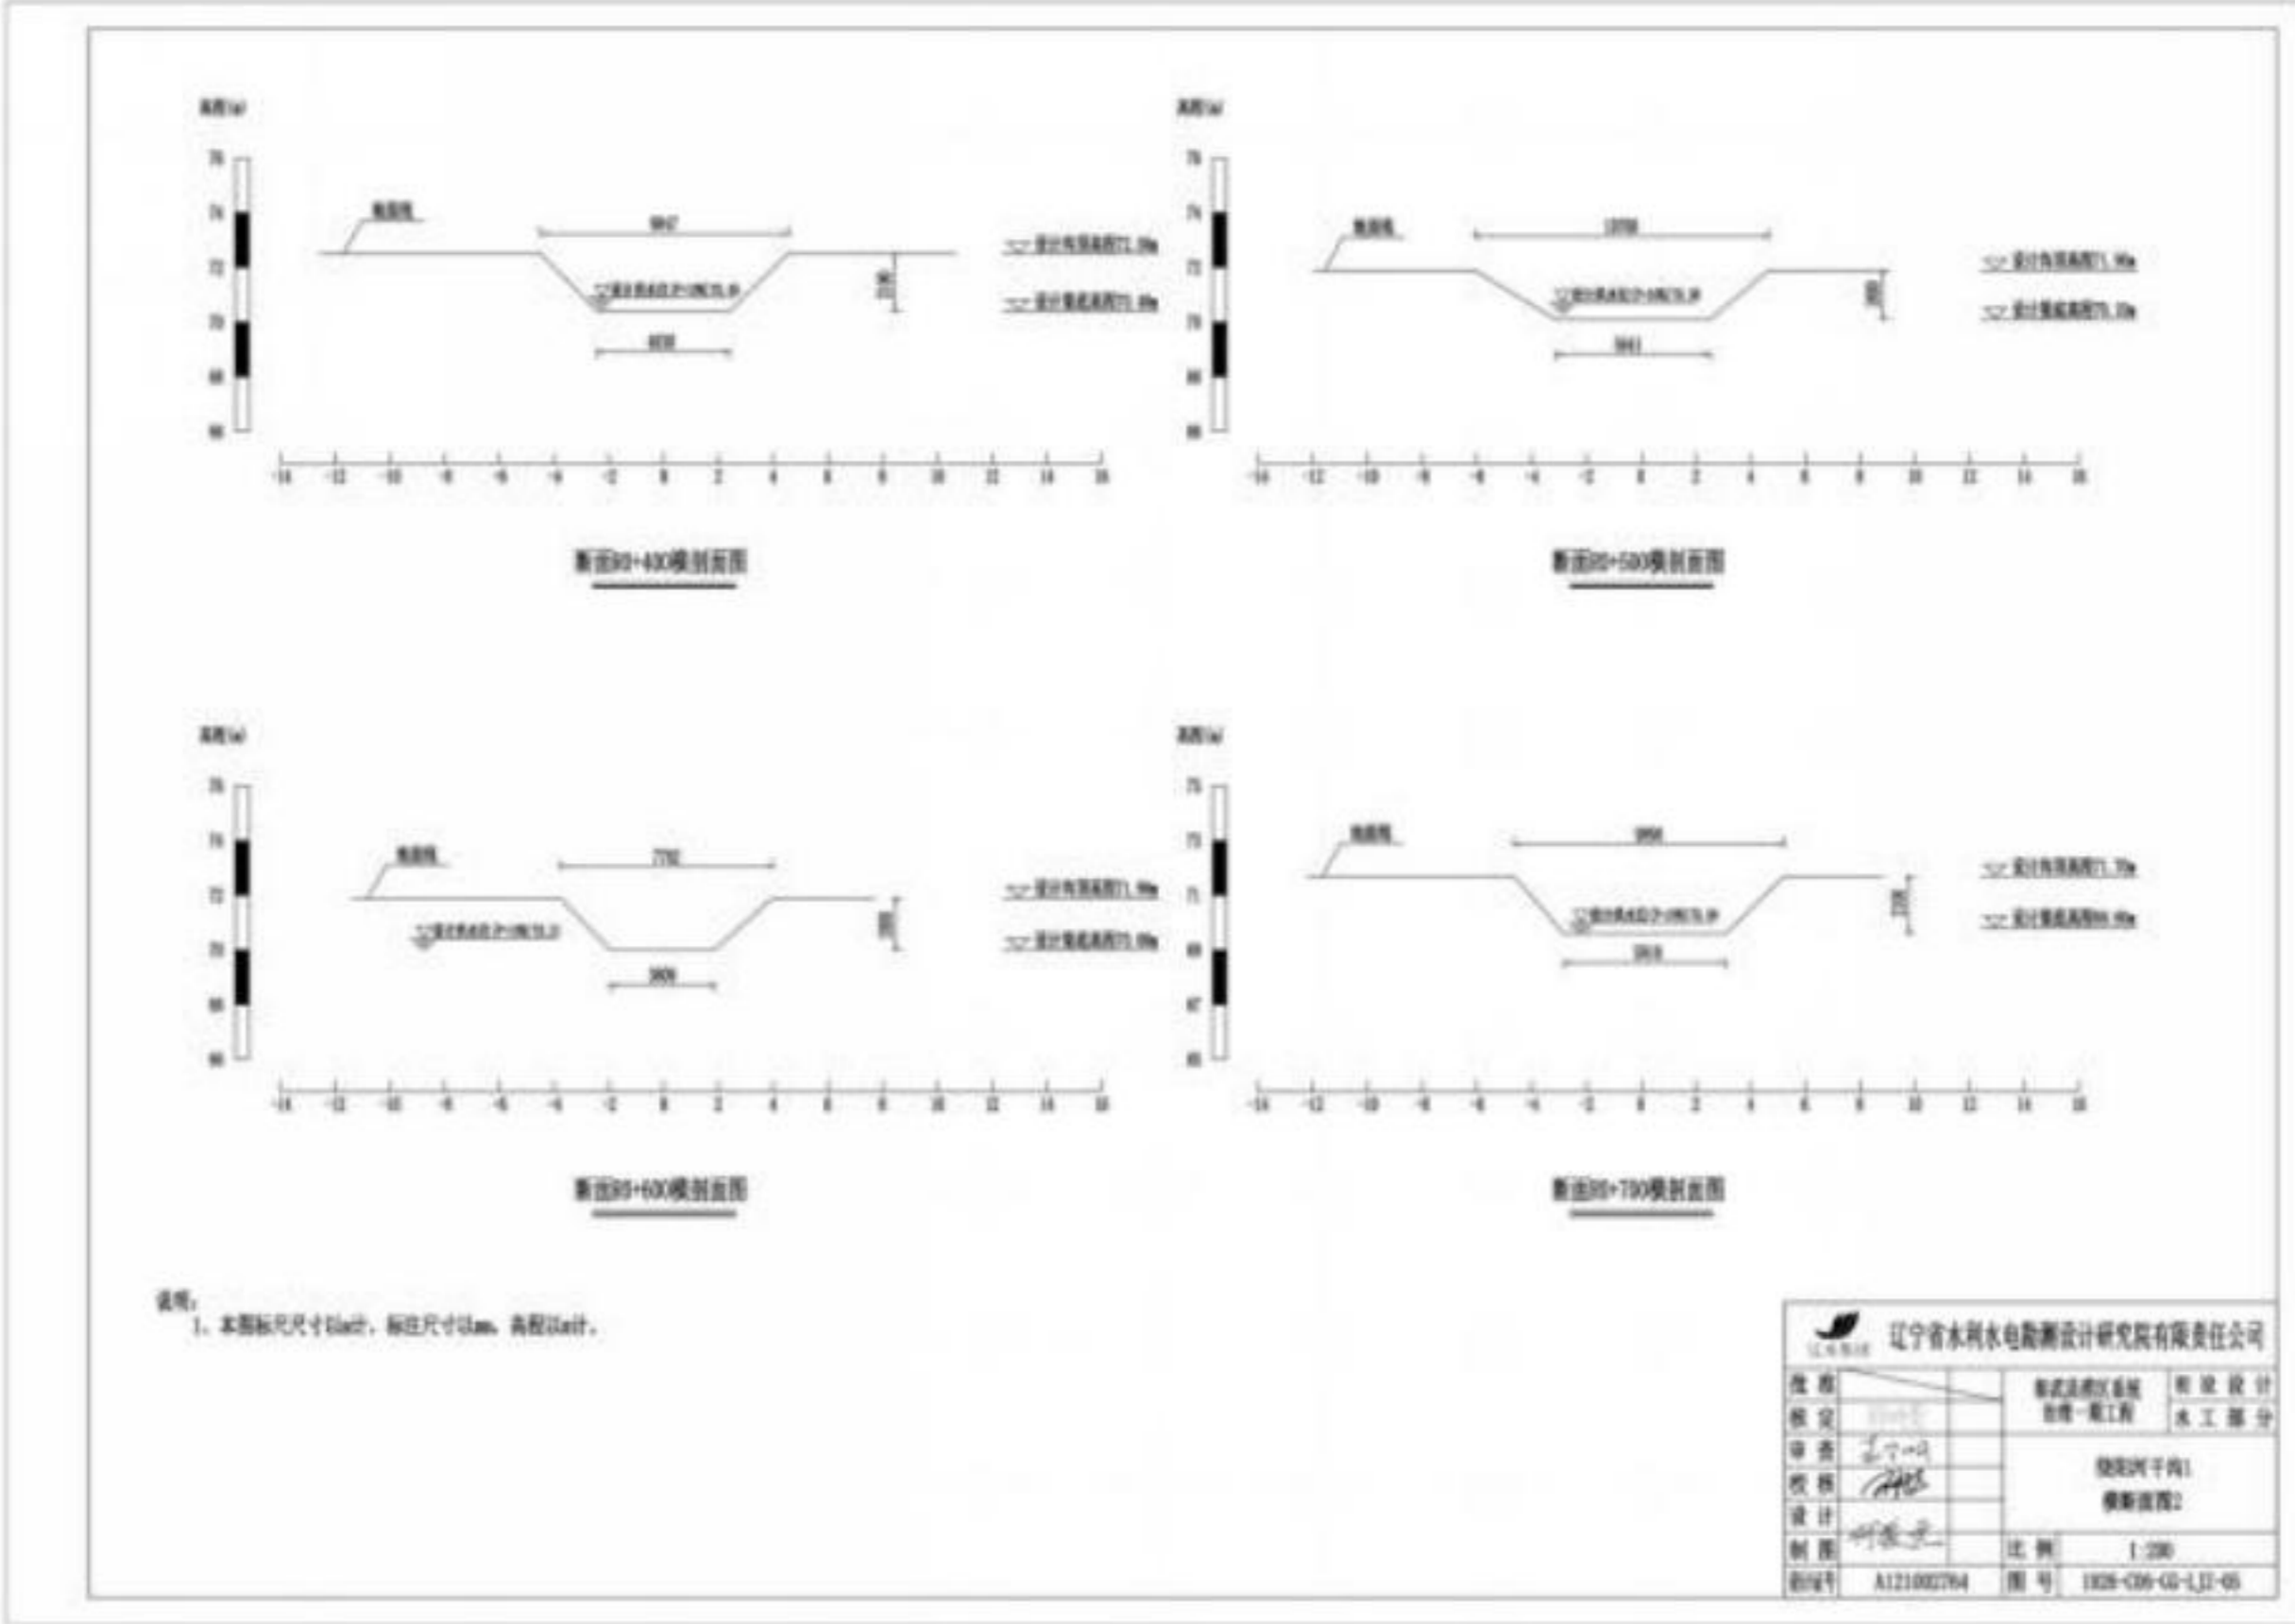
(2) 两家子镇绕阳河干沟 1 剖面图
